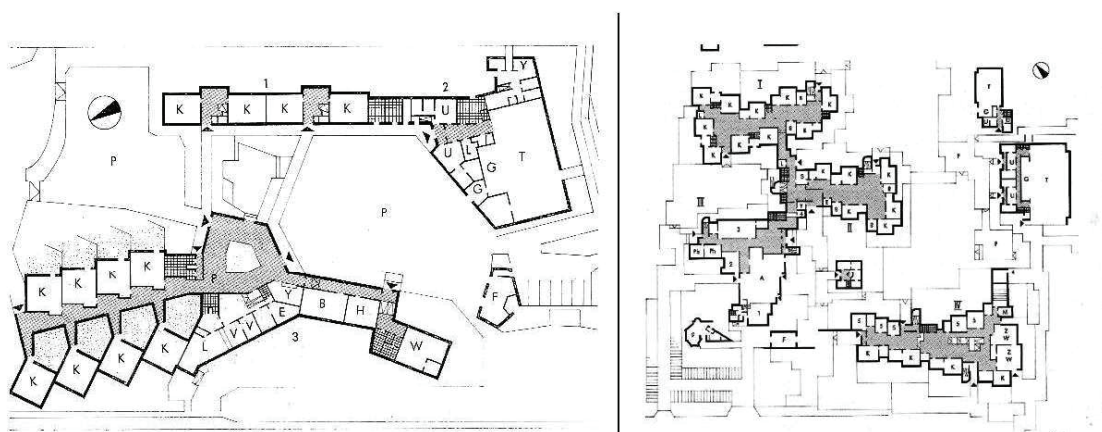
und 63: Schulbauten mit lockeren Grundrissen: links: Heinrich-Kromer-Schule Frankfurt-Main. rechts: Kennedy-Gesamtschule Berlin (Beide In: BUDDE; THEIL : 1969. 161; 209)
